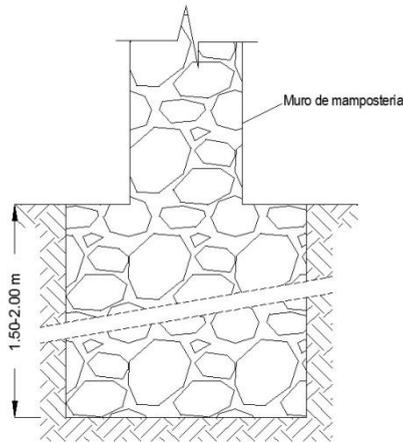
Detalle cimentación. 2015. Fuente: J.C.A.
